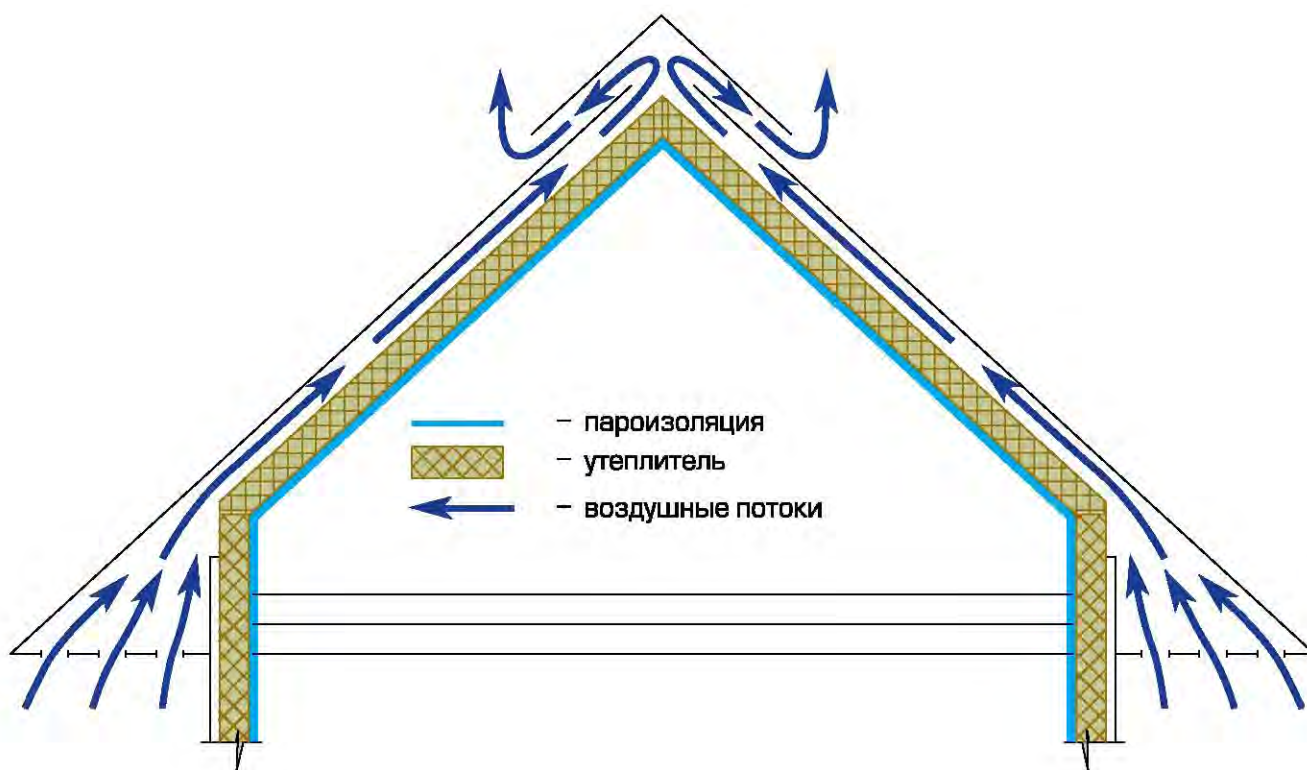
Схема утепления, пароизоляции и вентиляции «жилой мансарды»
